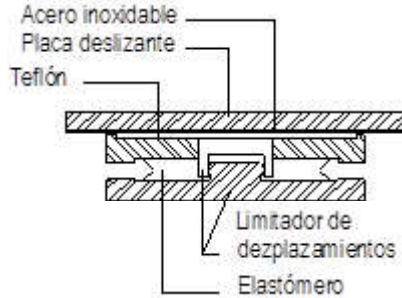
Esquema de un dispositivo aislador sísmico de base del tipo deslizante plano.
